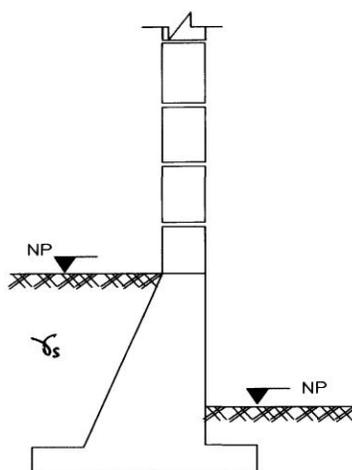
Mecanismo de funcionamiento del sistema de muros de mampostería de piedra en terrazas para viviendas unifamiliares en urbanizaciones
